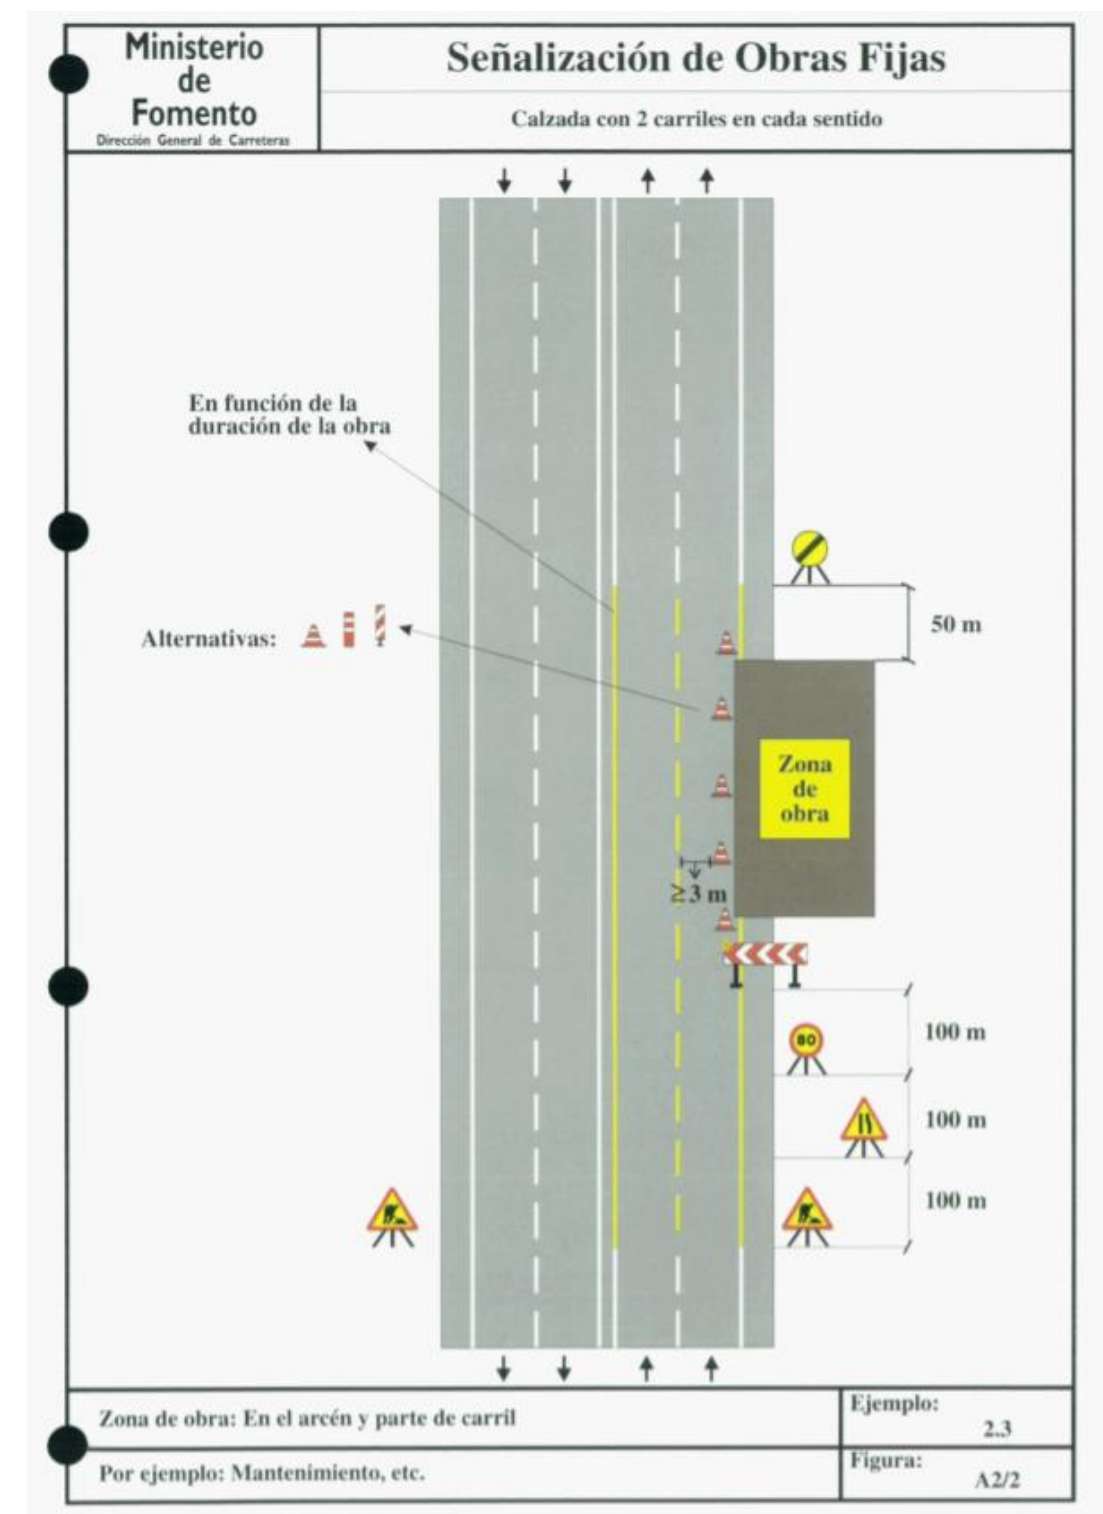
obras en la A6. Fuente: Señalización de obras fijas, Ministerio de Fomento
